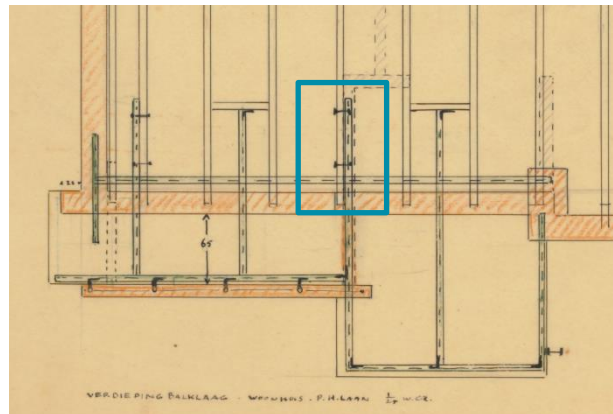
Constructietekening staalconstructie balkon oostgevel (Rietveld 1924)
